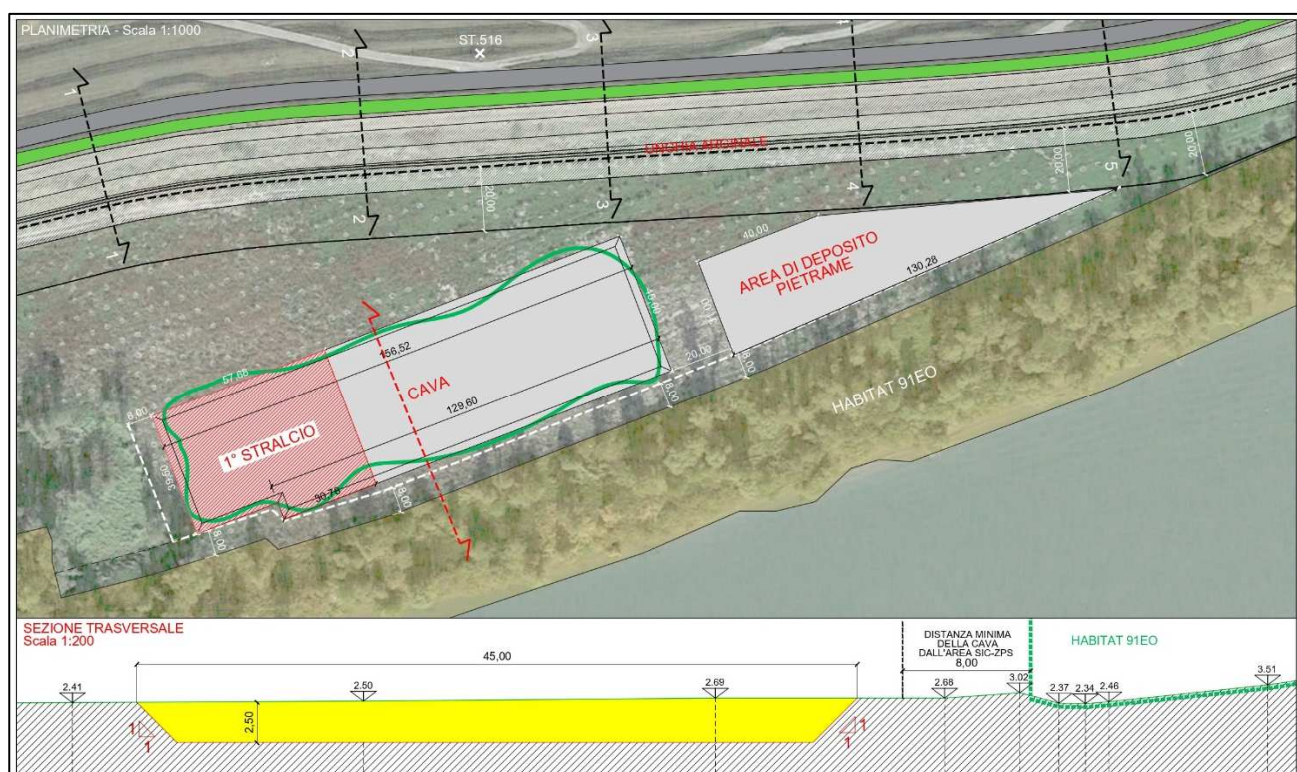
planimetria di progetto e sezione tipo area prelievo di progetto
